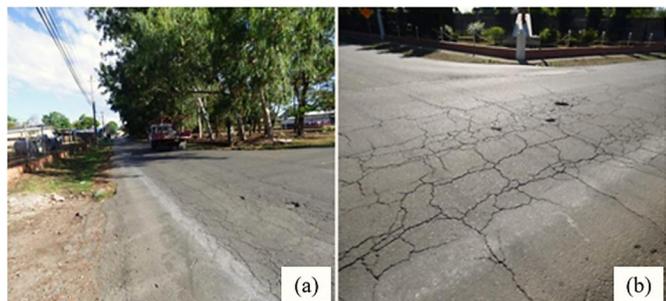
(a) Estado de la calle M Sur en mayo del 2022, (b) Falla de grietas de bloque presente en la calle M Sur.
